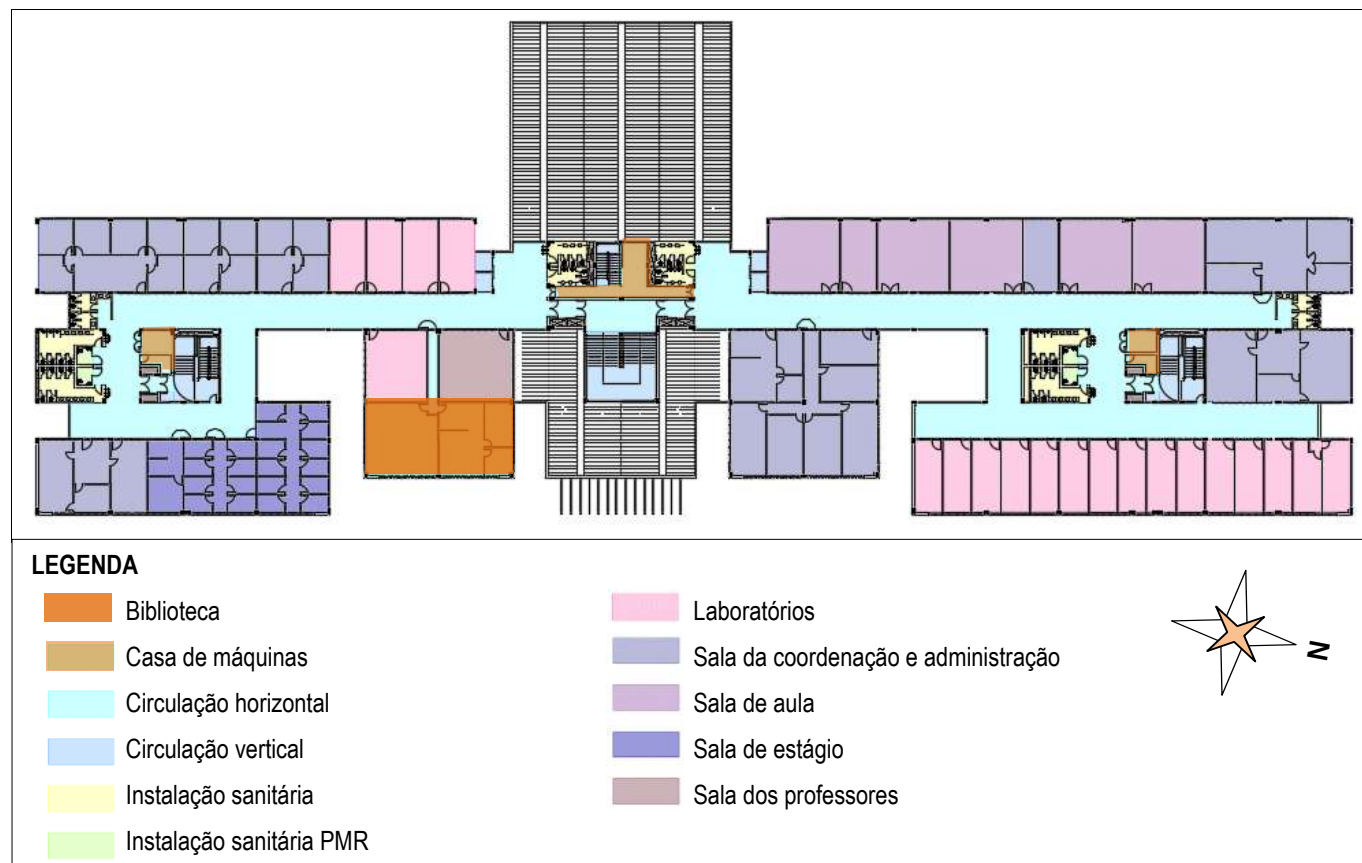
Planta setorializada do terceiro pavimento do bloco 07.
